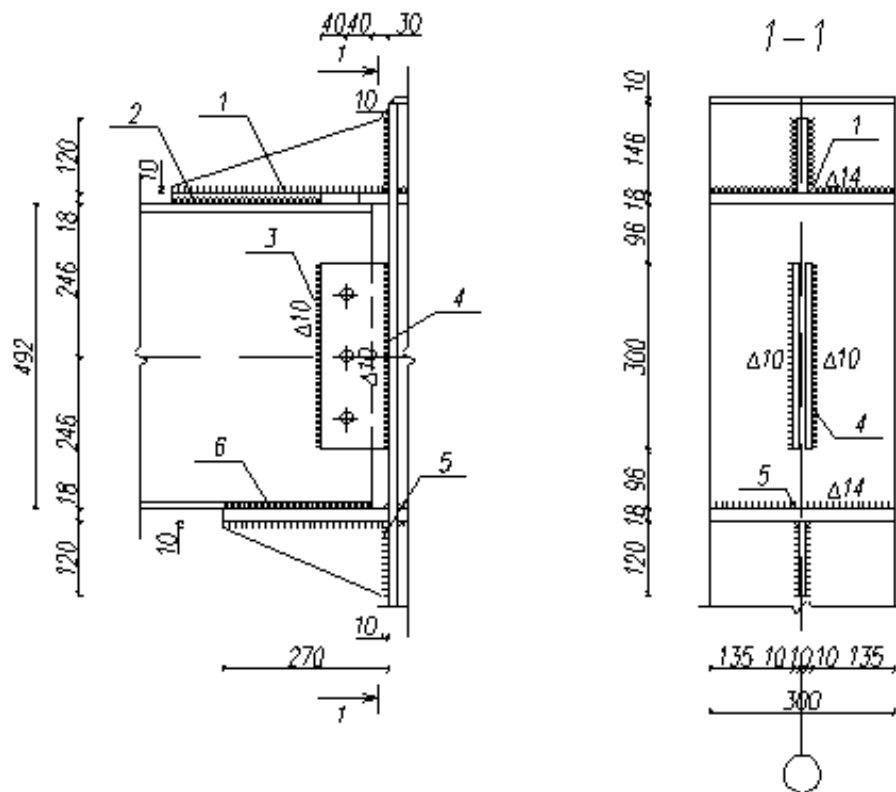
Схема кріплення ригеля до колони, вузол 1.
